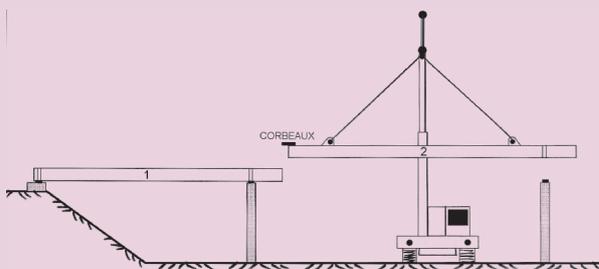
Schéma de pose à la grue terrestre avec tronçons sensiblement de même longueur que les travées
